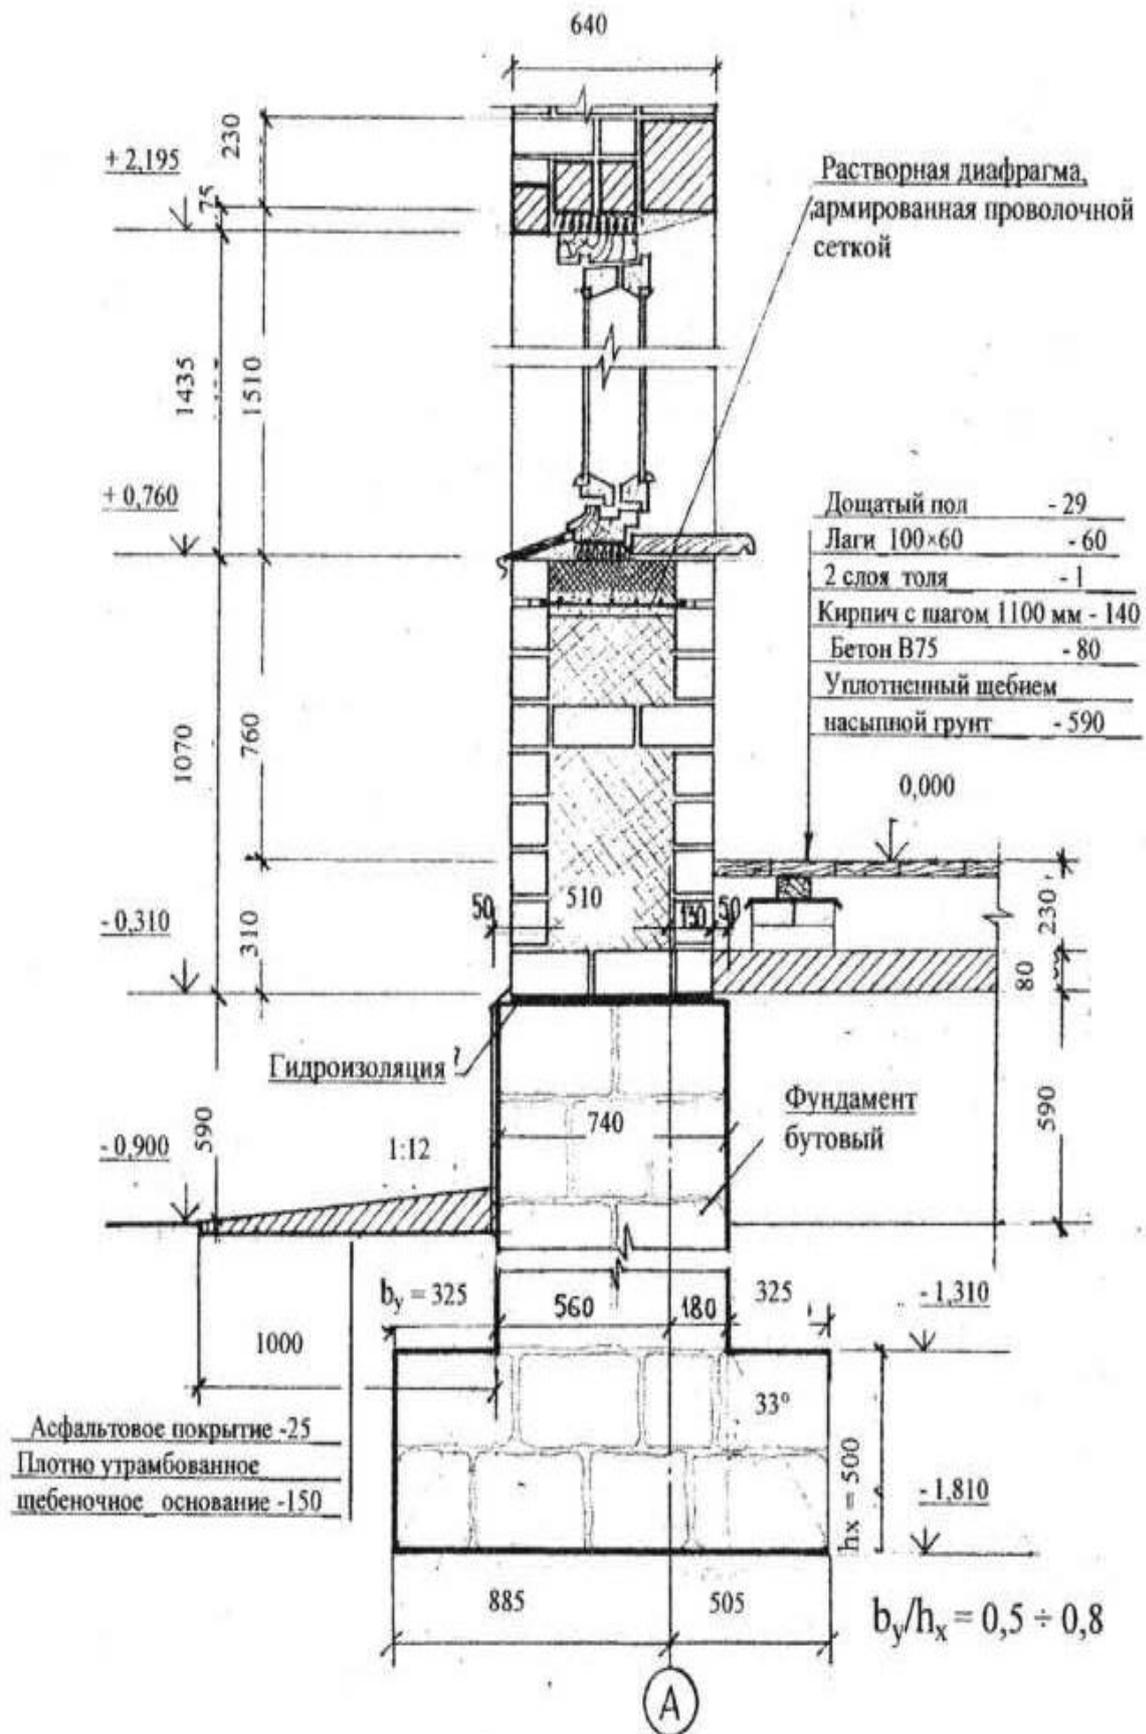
Конструктивный разрез по кирпичной стене с бутовым фундаментом
